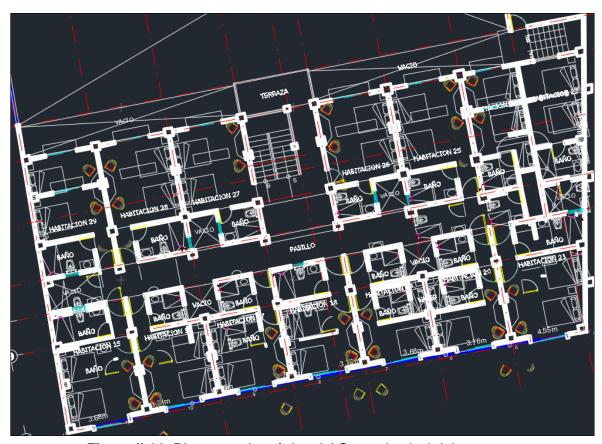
Planta arquitectónica del Segundo nivel del proyecto.
